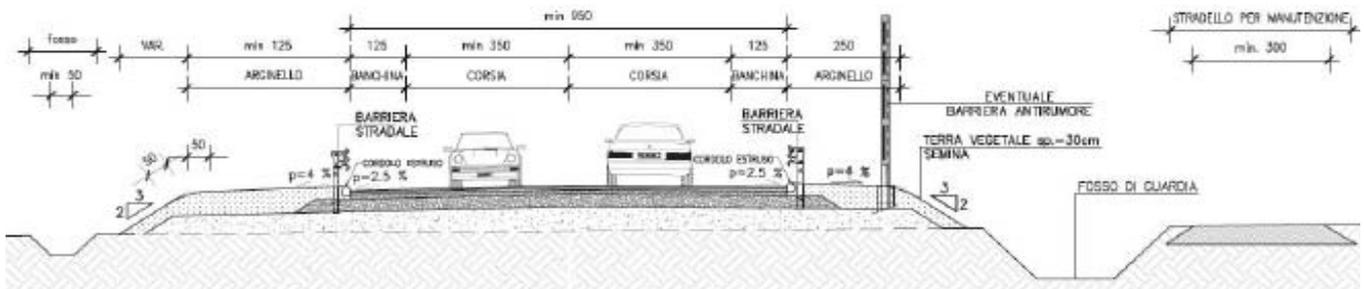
Sezione tipo piattaforma C2 in affiancamento al passante
